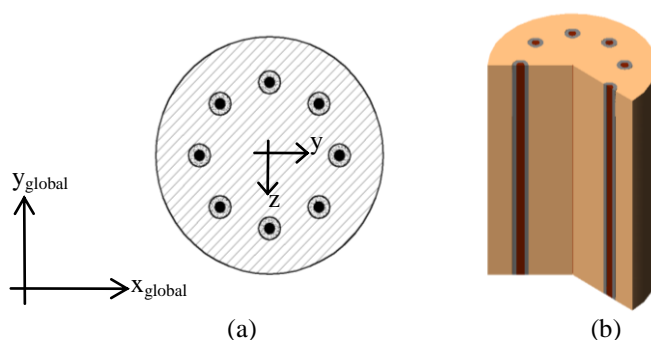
Solução 4 - Reforço da secção transversal dos pilares da nave com armadura ordinária (8Ø32):
